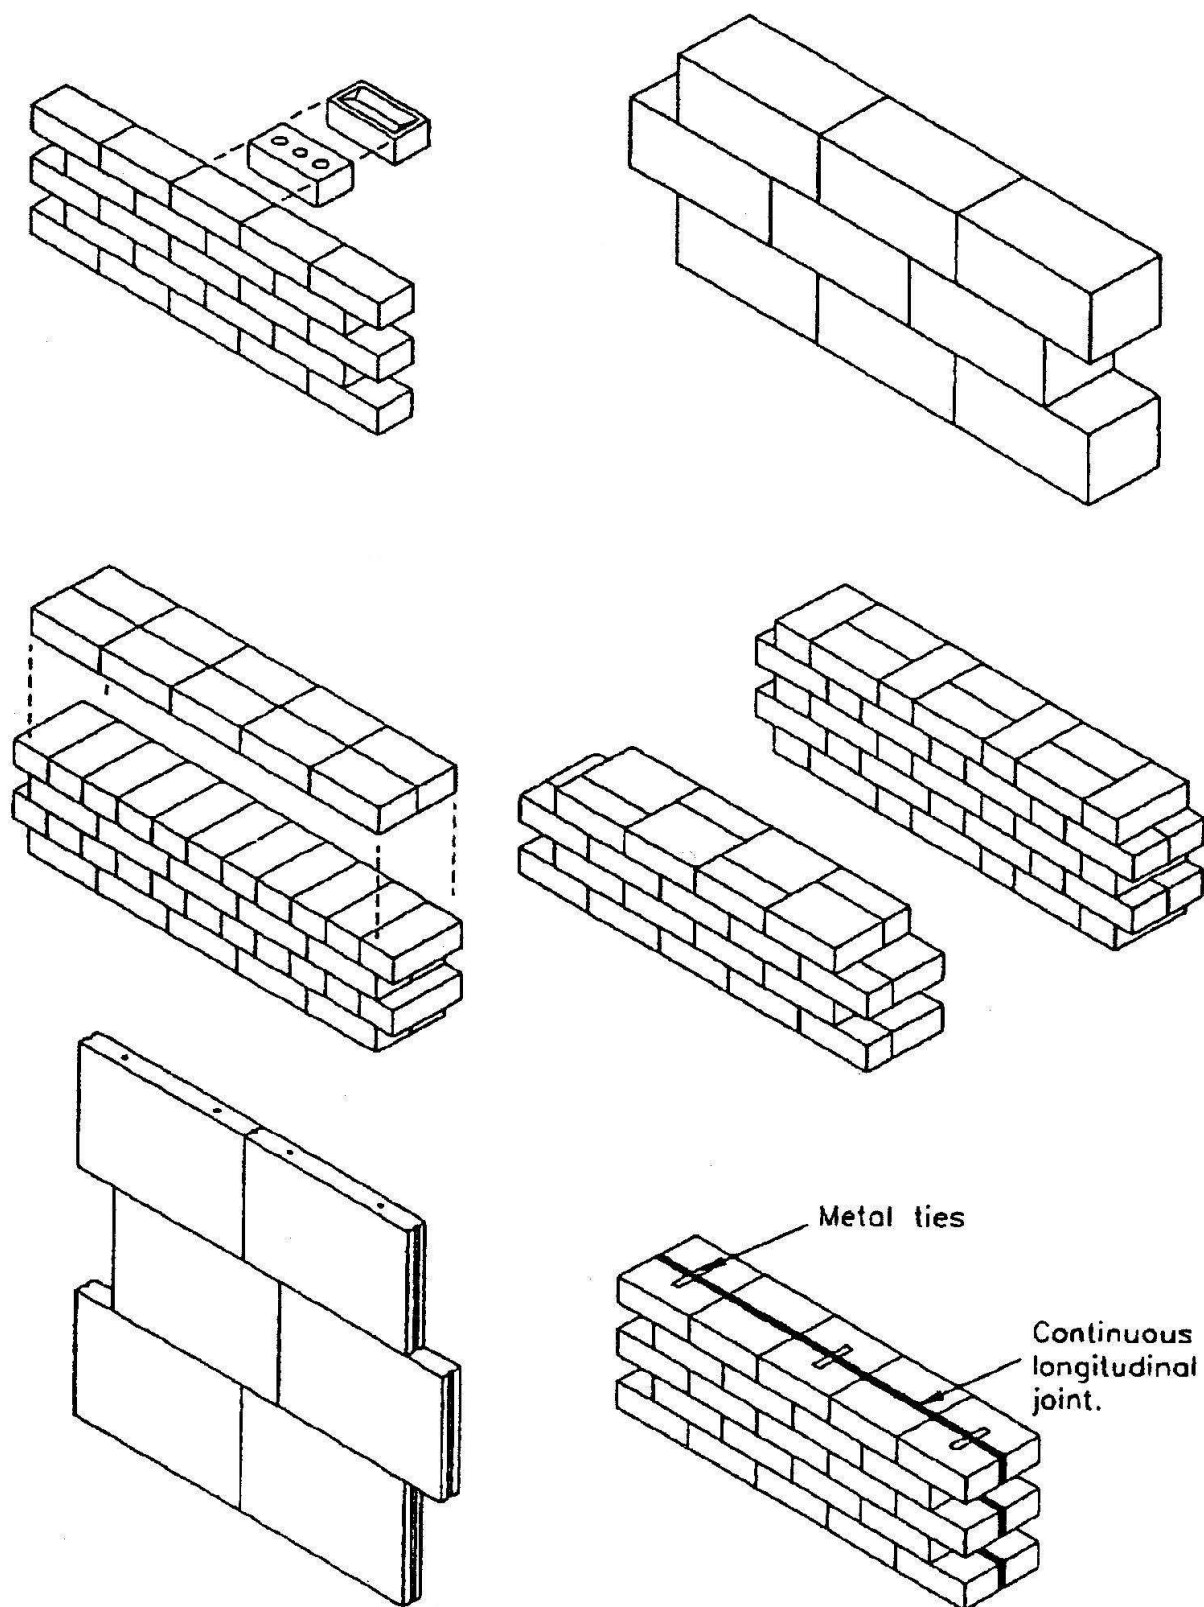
Примеры перевязок каменных кладок с использованием кирпича 1 группы.
